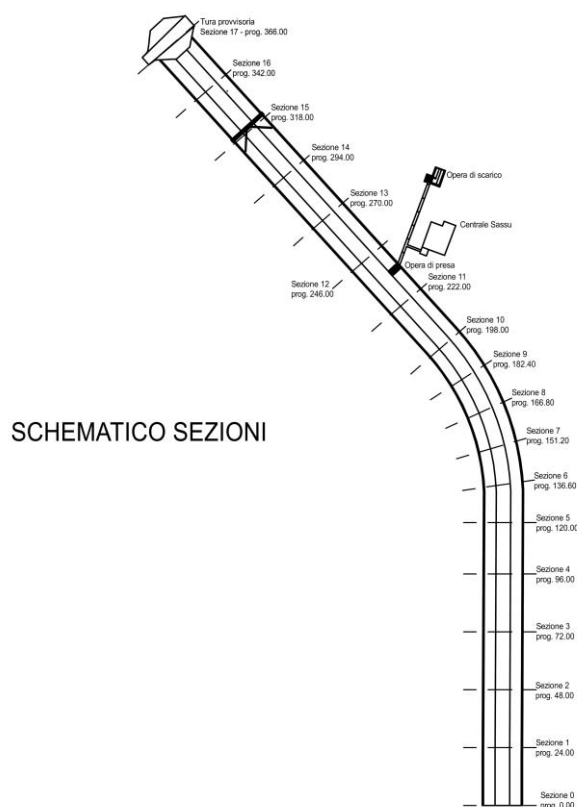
Planimetria con Sezioni, corrispondenza conci e ubicazione degli interventi in progetto.
